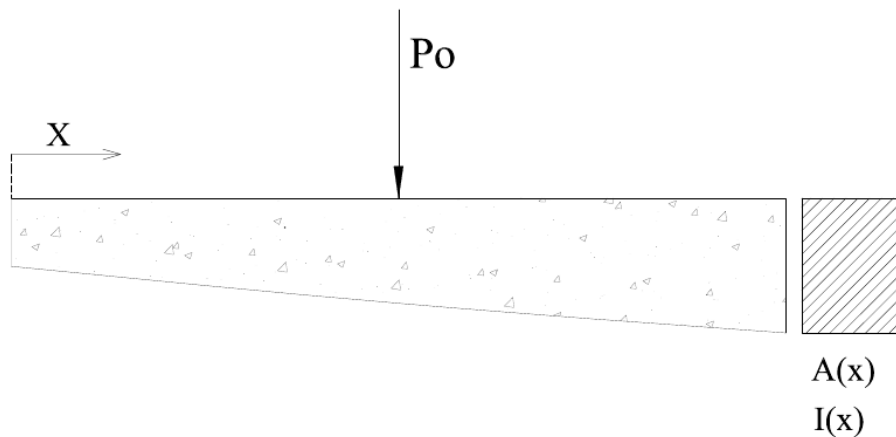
Esquema de carga móvil sobre viga de sección variable.
